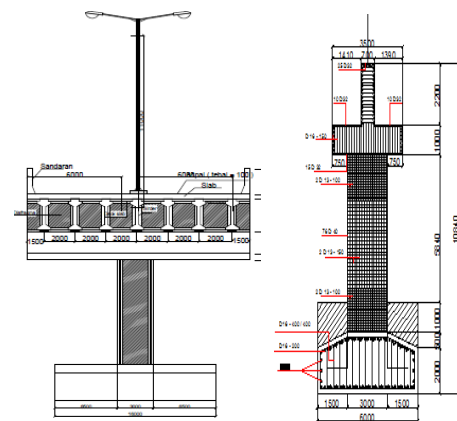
Detail tulangan dan tampak melintang ABT-1 - 2
